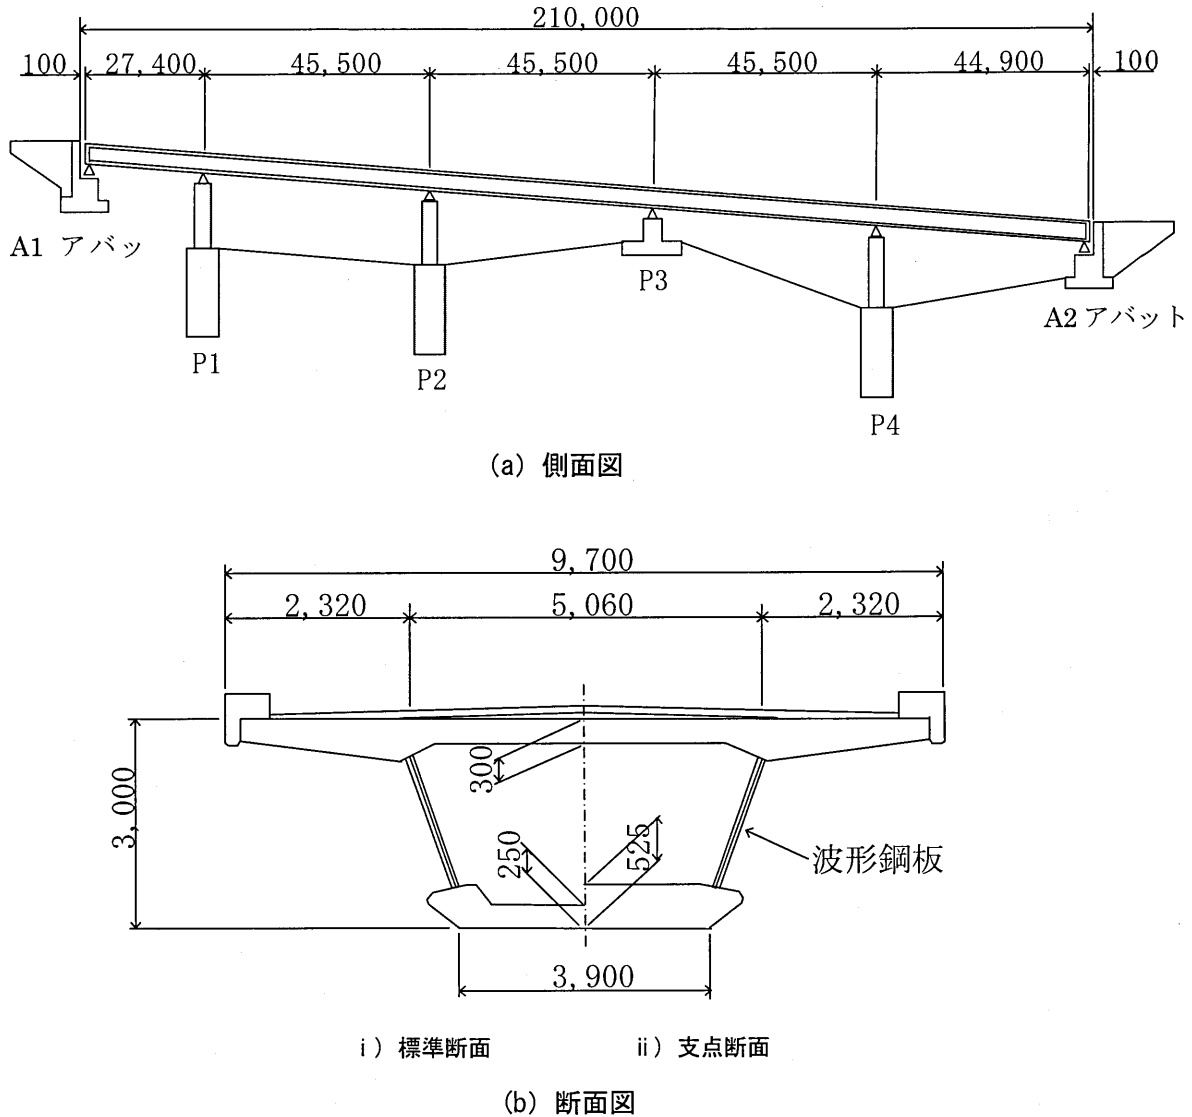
銀山御幸橋の一般図(寸法単位:mm)
